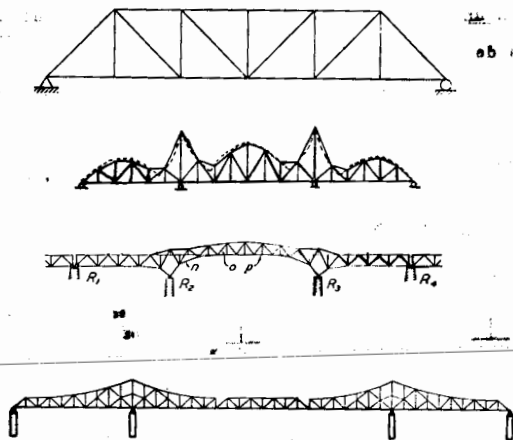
Distintos tipos de puentes con armaduras
